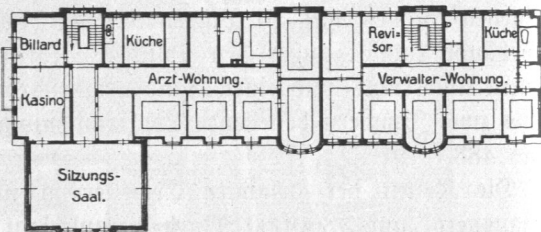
Irrenanstalt Friedrichsberg, Verwaltungsgebäude, Obergeschoss, Grundriß.
